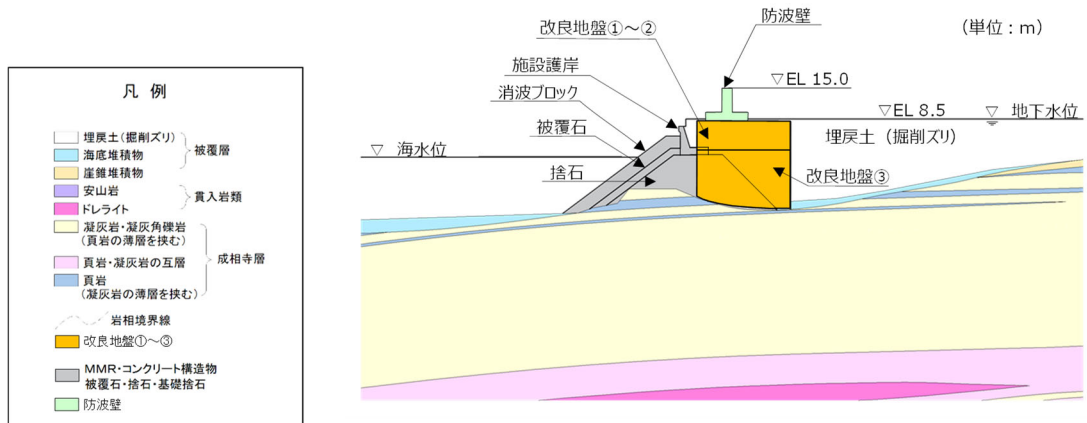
防波壁 (逆 T 擁壁) の横断面図 (⑤-⑤断面)
